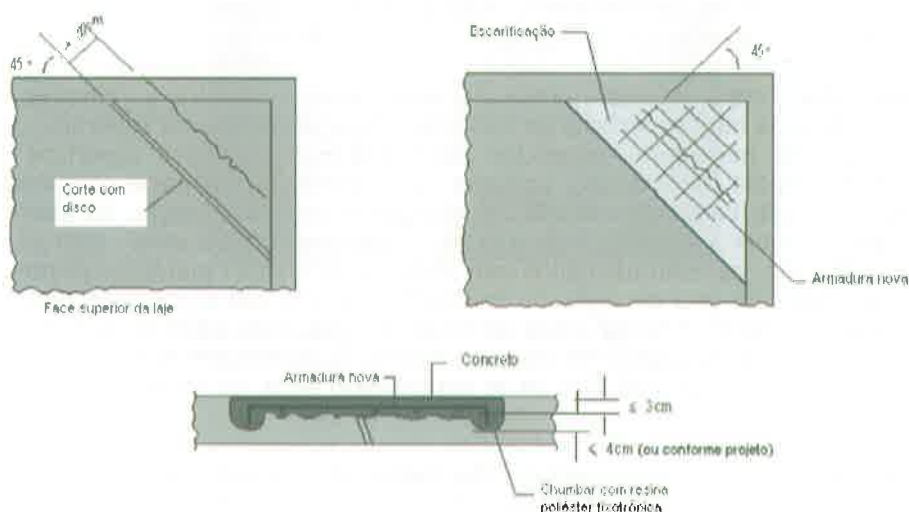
Reforço de momentos volventes em lajes com concreto.
